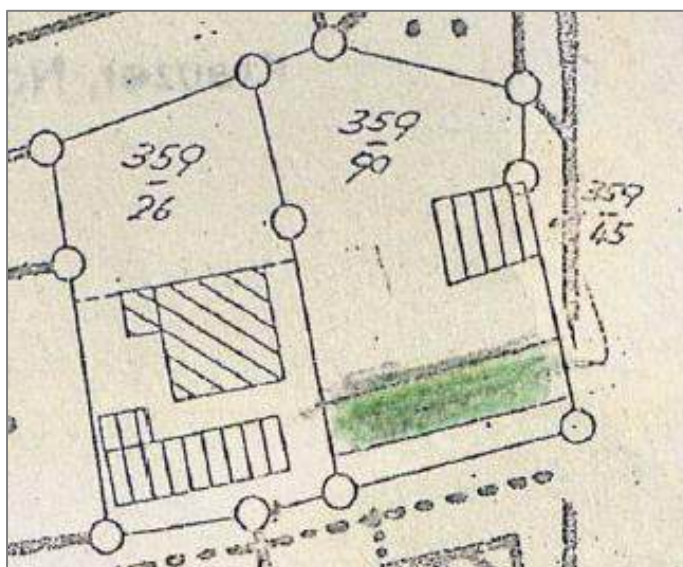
/ Quelle: Ausschnitt Lageplan Bewilligungsurkunde
